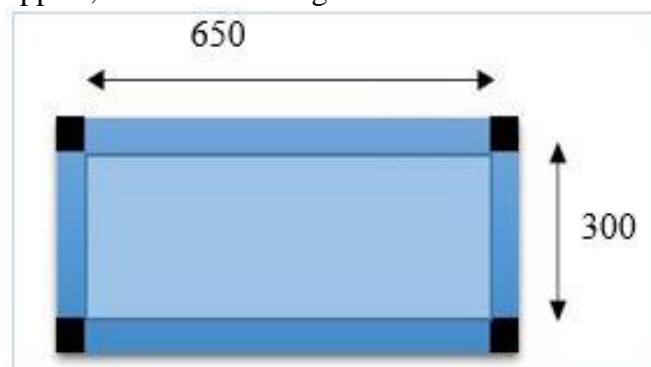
Panneau de dalle pleine sur 4 appuis.
